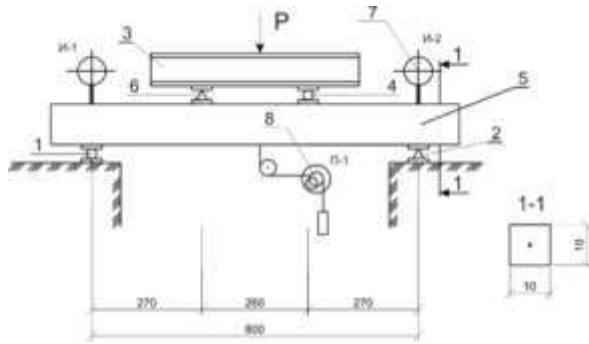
Схема испытания балки на двух опорах 1 - подвижная опора; 2- неподвижная опора; 3- распределительная балка; 4- подвижная опора распределительной балки; 5- испытываемая балка; 6- неподвижная опора; 7- индикаторы часового типа; 8- прогибомер ПАО-6
